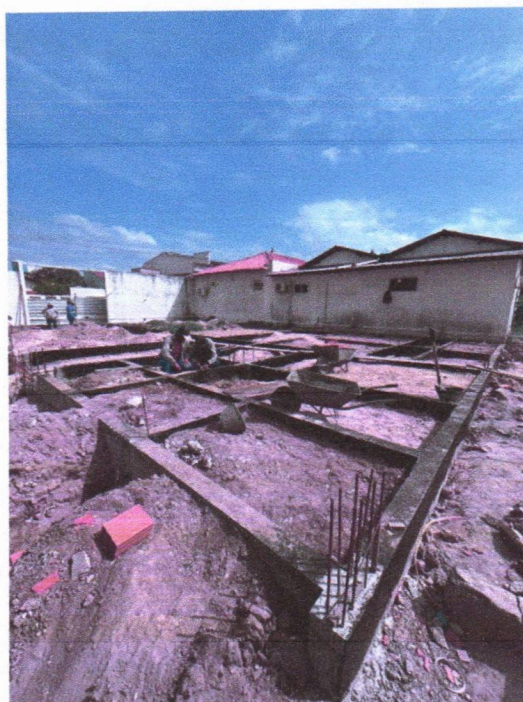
Execução das vigas baldrame e impermeabilização;
